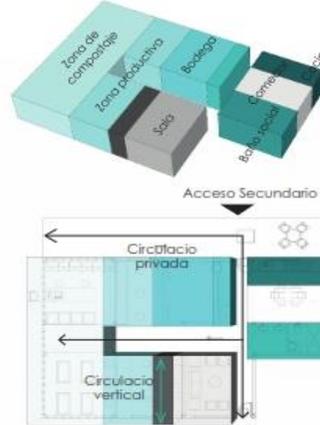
Planta Baja(Tipología 3). Fuente: Elaboración Propia.
